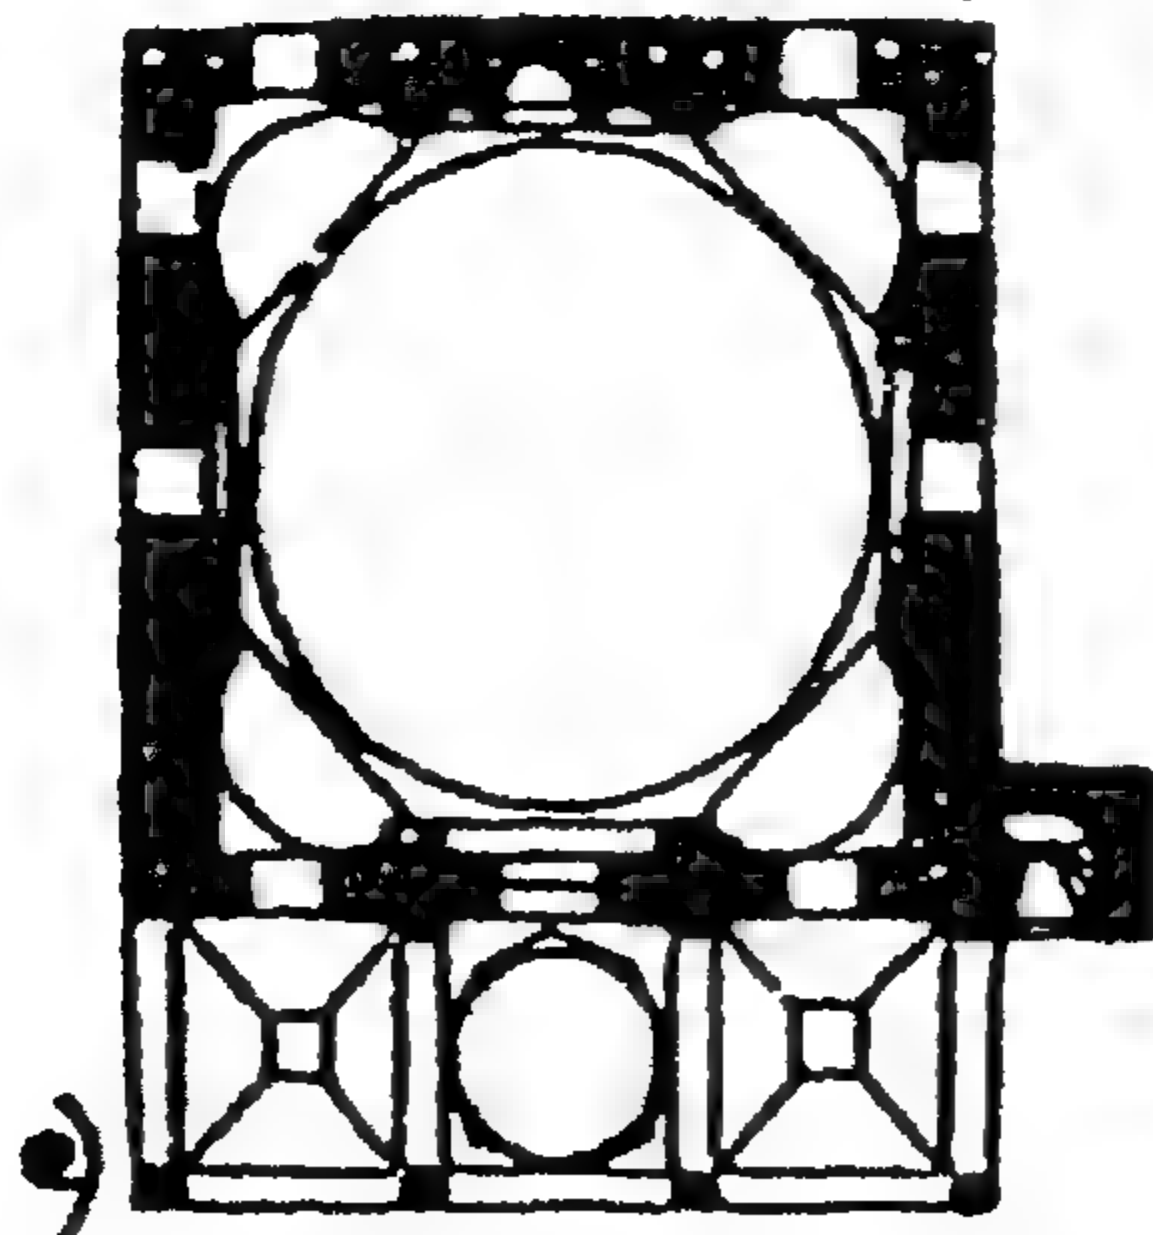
مسقط أفقي لمسجد علي باشا في Szigetvar المجرية (عن : جيرو) .
